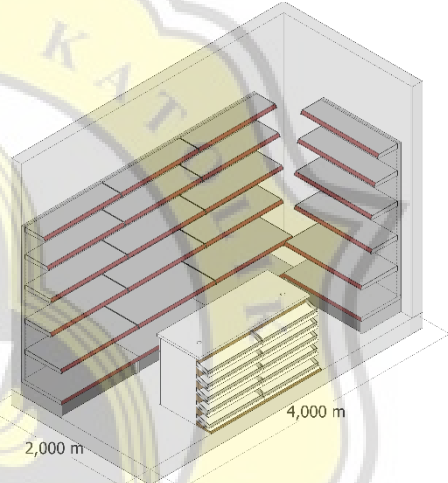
Layout *Tenant* 4×2 meter Klaster Kuliner
